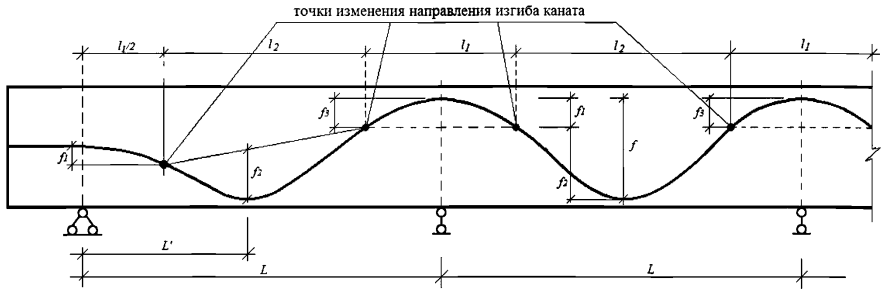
Геометрия раскладки арматурных элементов по высоте сечения конструкции по траекториям пролетных и опорных парабол
